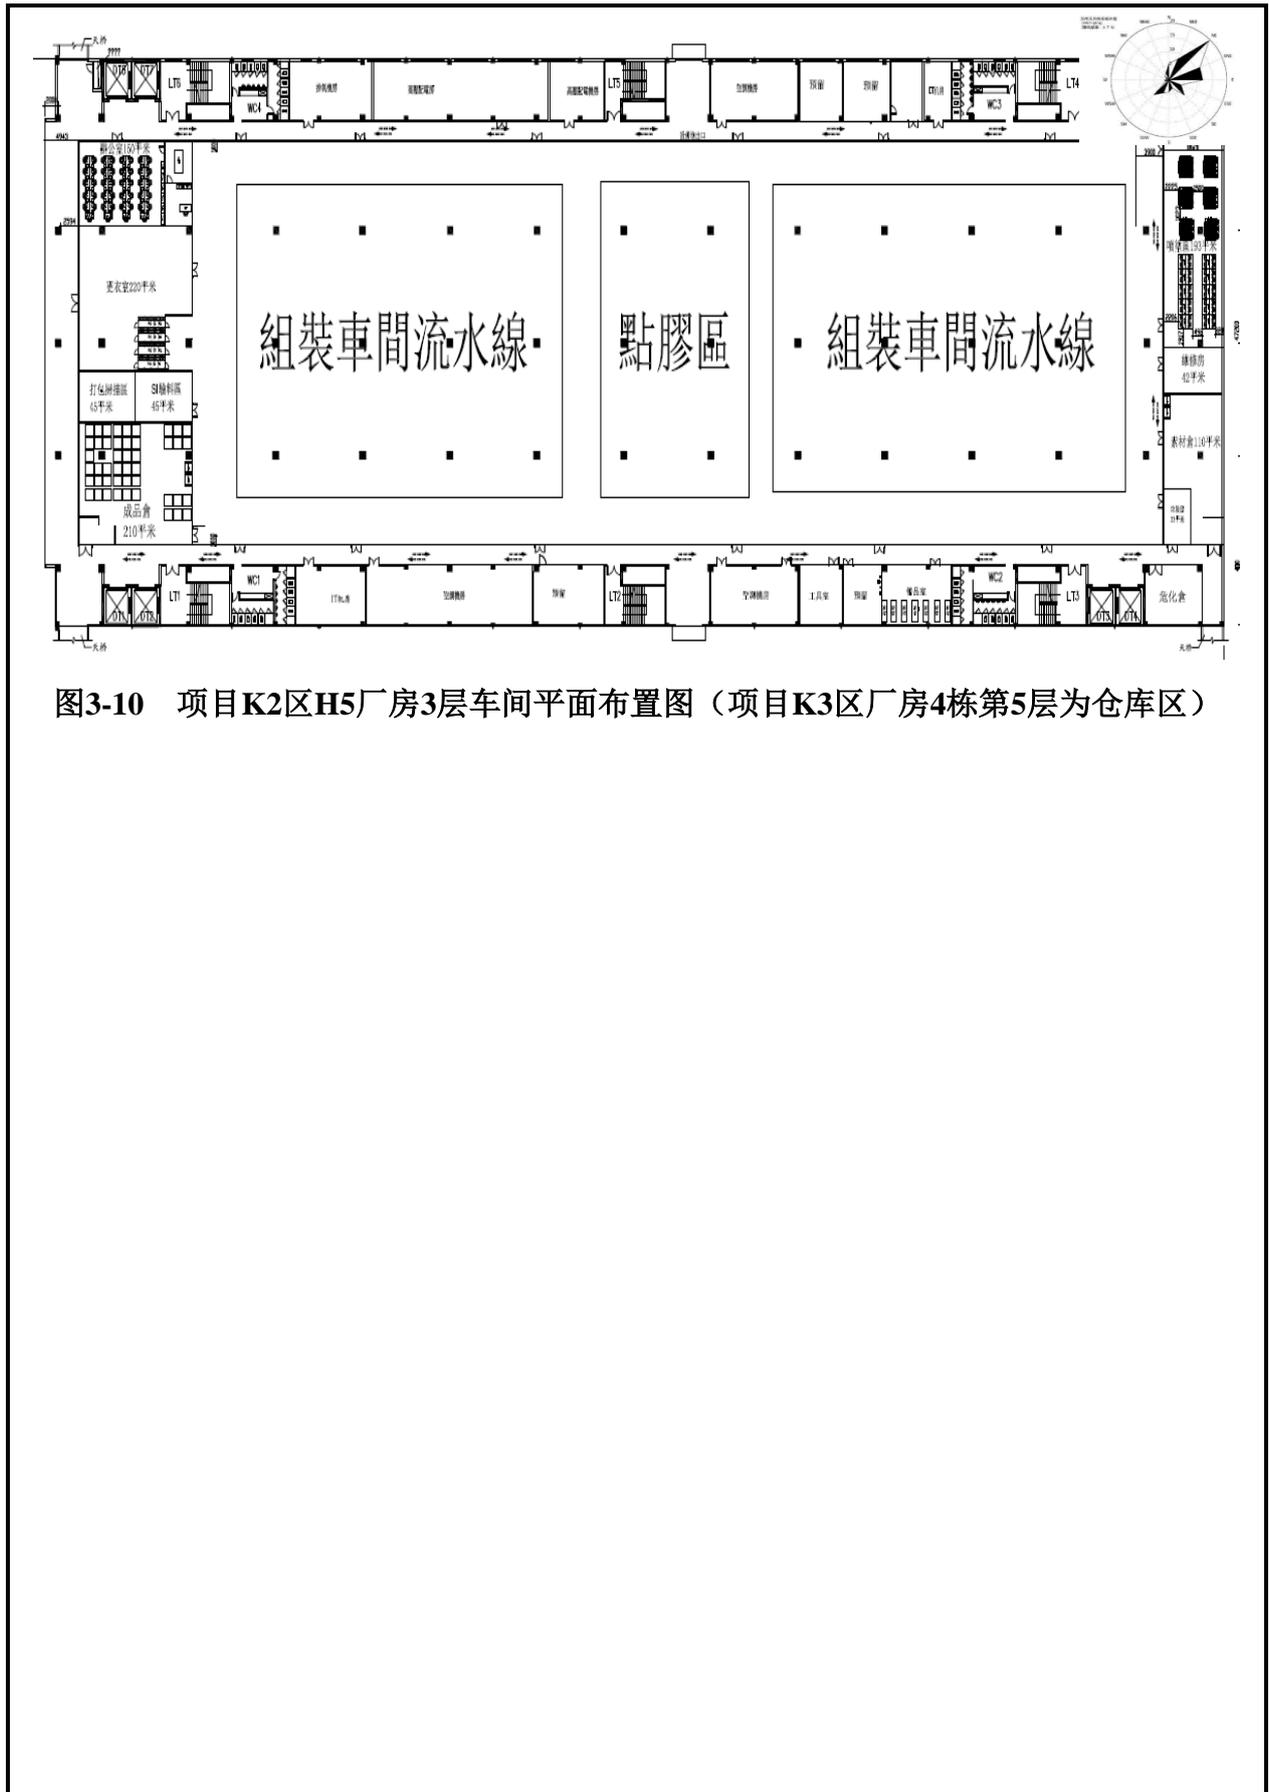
项目K2区H5厂房3层车间平面布置图（项目K3区厂房4栋第5层为仓库区）
